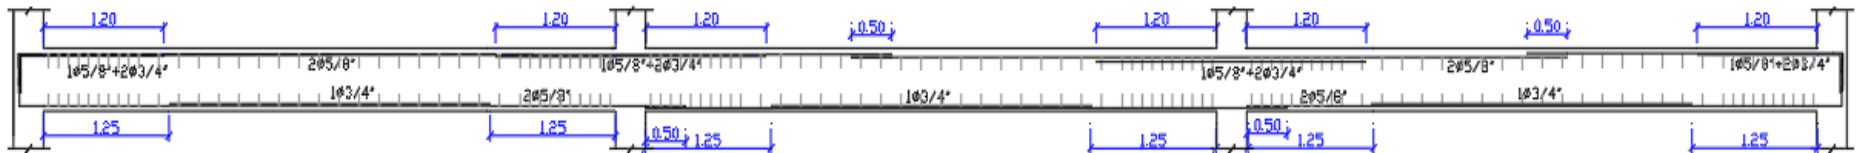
Vista elevación del detalle de refuerzo de la viga V-T07 en el 1° nivel.
